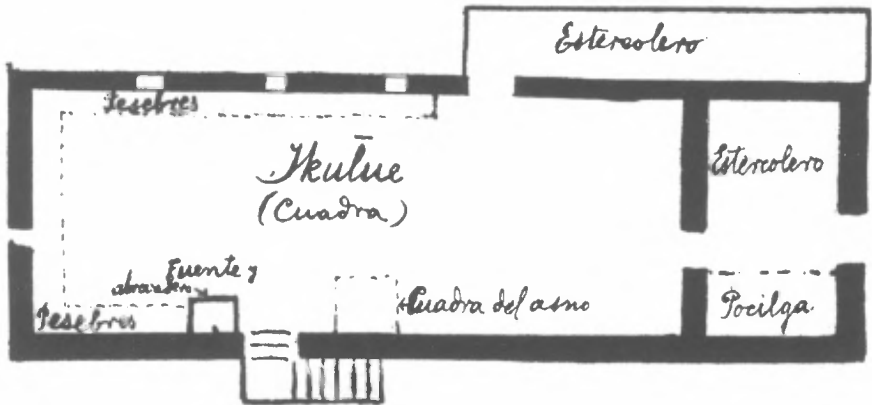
Telázpiko: Planta baja (casa moderna).
